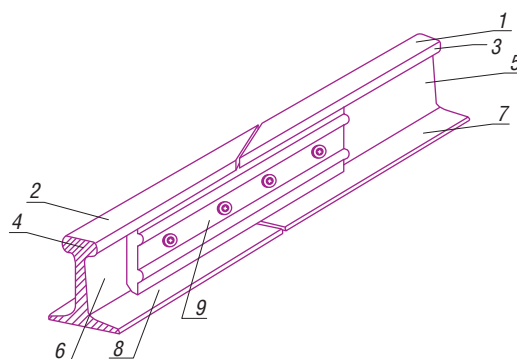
Косой рельсовый стык для соединения двух рельсов: 1 и 2 — рельсы; 3 и 4 — головки рельсов; 5 и 6 — шейки; 7 и 8 — подошвы рельсов; 9 — накладки.
